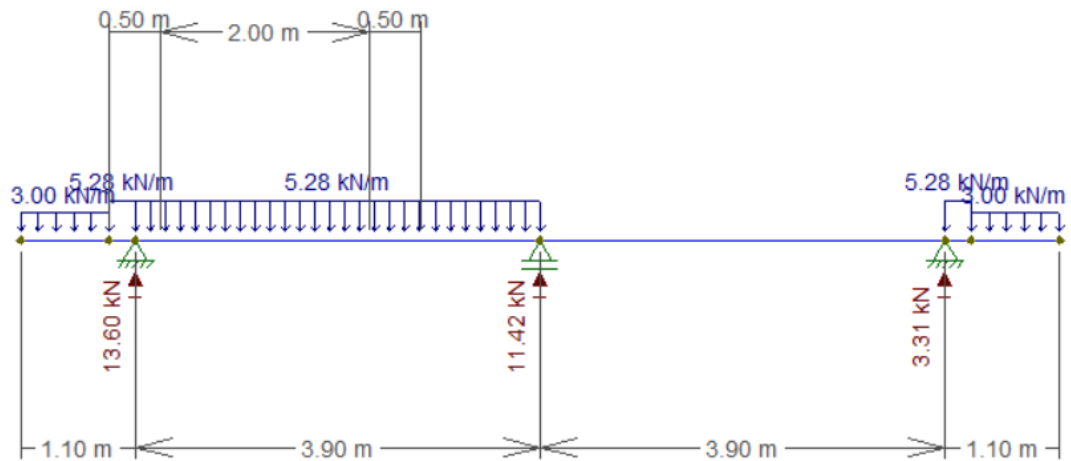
Reação de apoio na Viga Principal 1 (VP1) oriunda da aplicação do veículo-tipo
